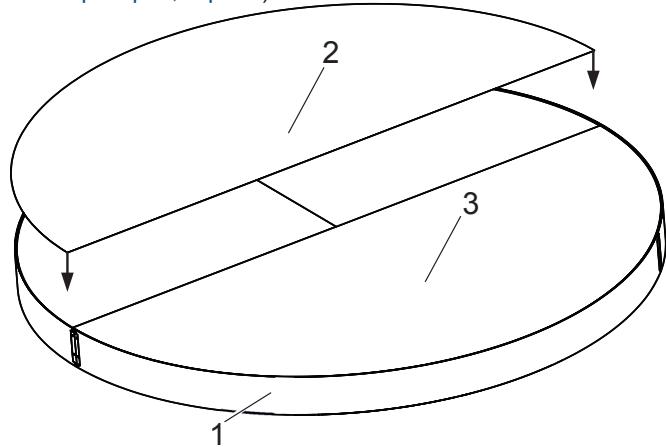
Сборка металлической верхней части потолка с защитой от дождя
